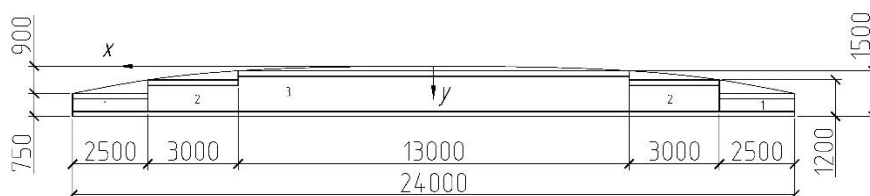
Стропильная балка-плита коробчатого поперечного сечения
